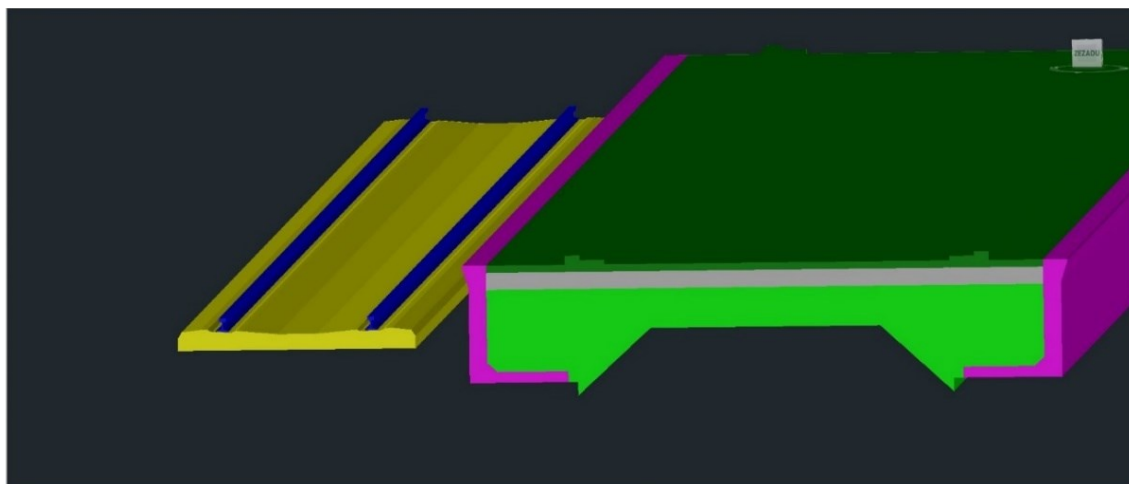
Charakteristický příčný řez s planimetrií ploch
